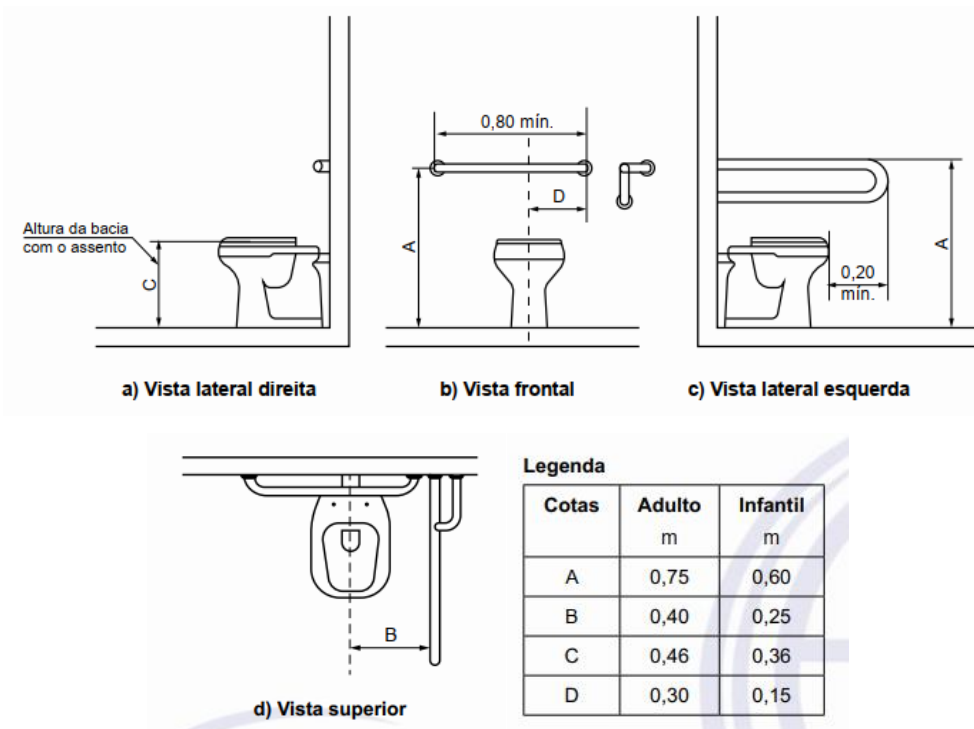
Sem parede lateral – Bacia convencional ou suspensa com barras de apoio reta e lateral fixa – Exemplo A
